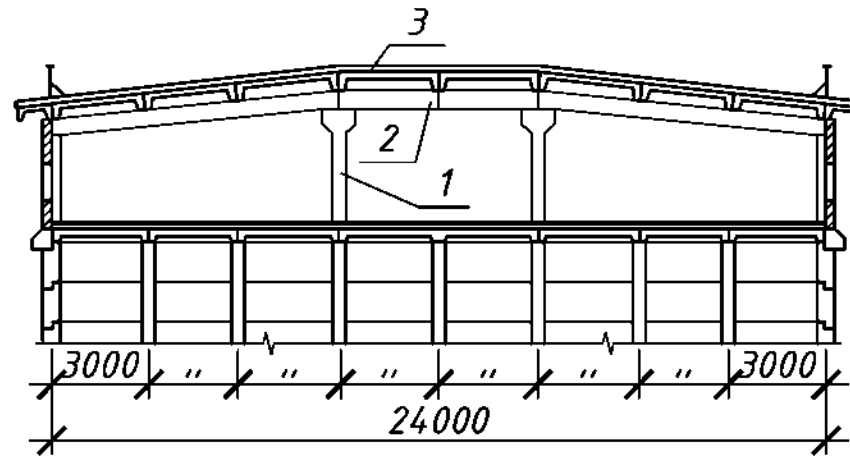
Надсилосний поверх силосного корпусу СКЗ-3-96:
